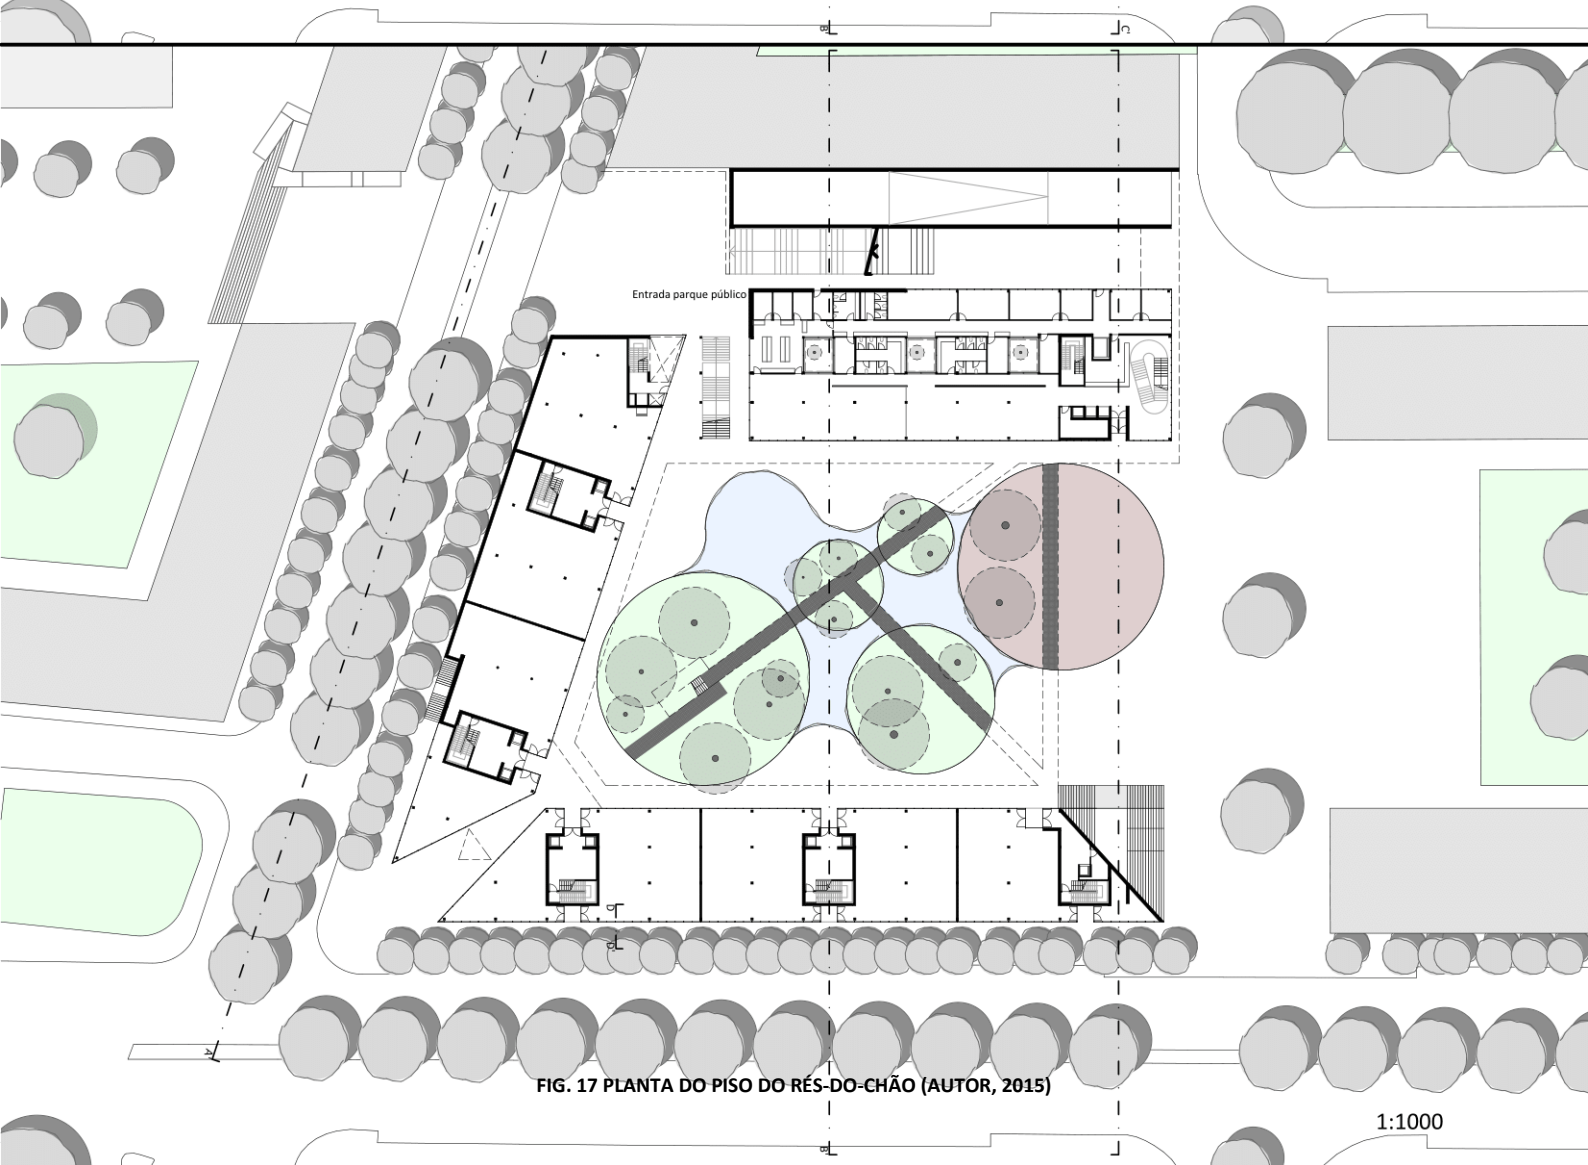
PLANTA DO PISO DO RES-DO-CHÃO (AUTOR, 2015)
